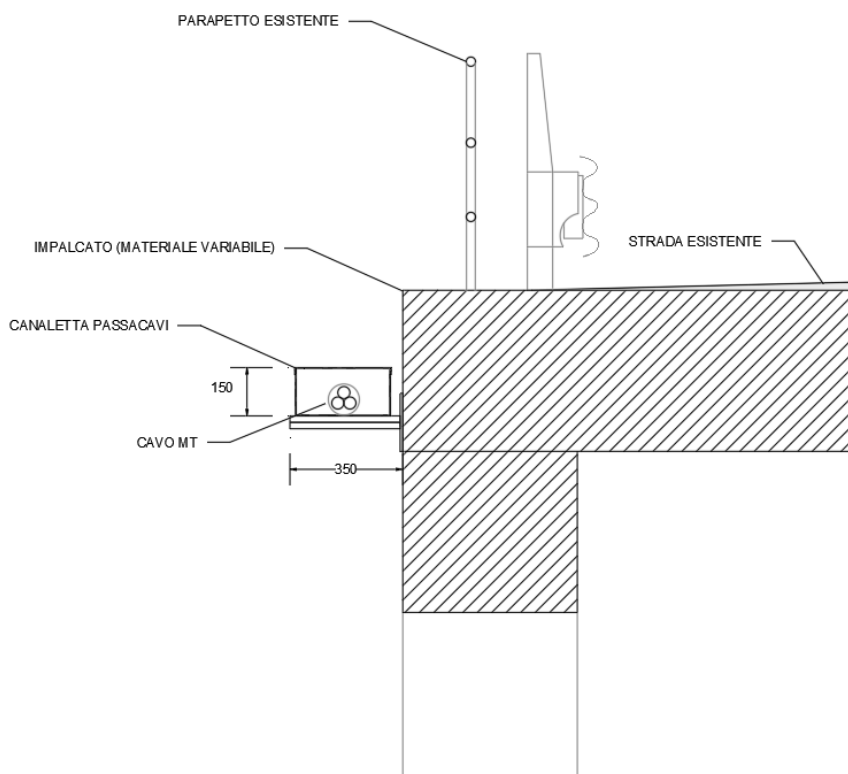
Tipologico della sezione del cavidotto in canaletta in fiancheggiamento dell'attraversamento carrabile per cavo MT.
